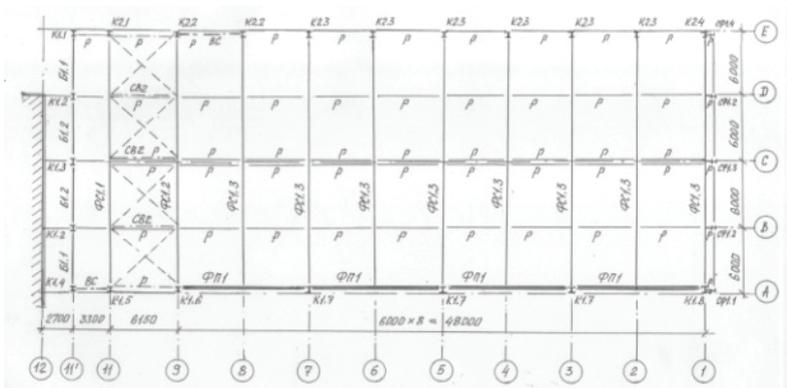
Схема расположения элементов каркаса здания цеха №1
